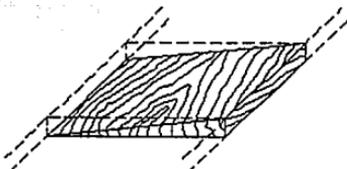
Orientación de las fibras en cuñas de madera.
